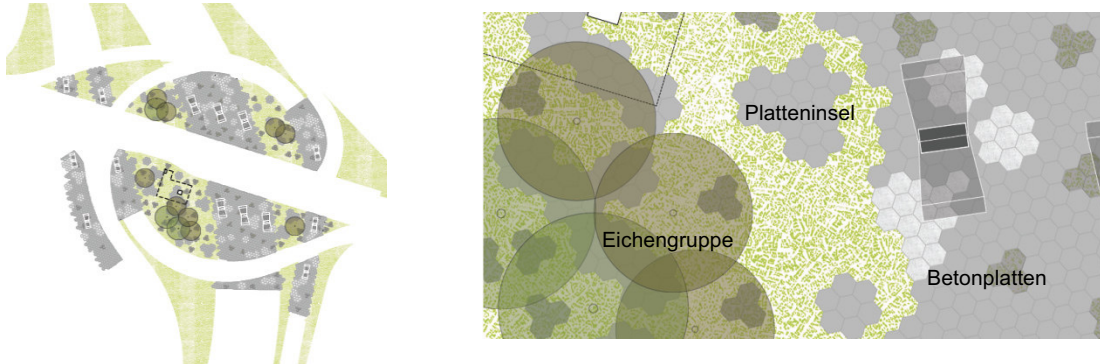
Übersicht und Detail Variante mit Betonplatten
